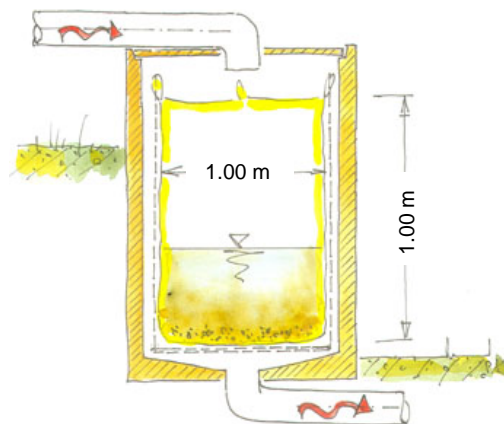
Schnitt durch den Schacht mit dem Geotextilsack
